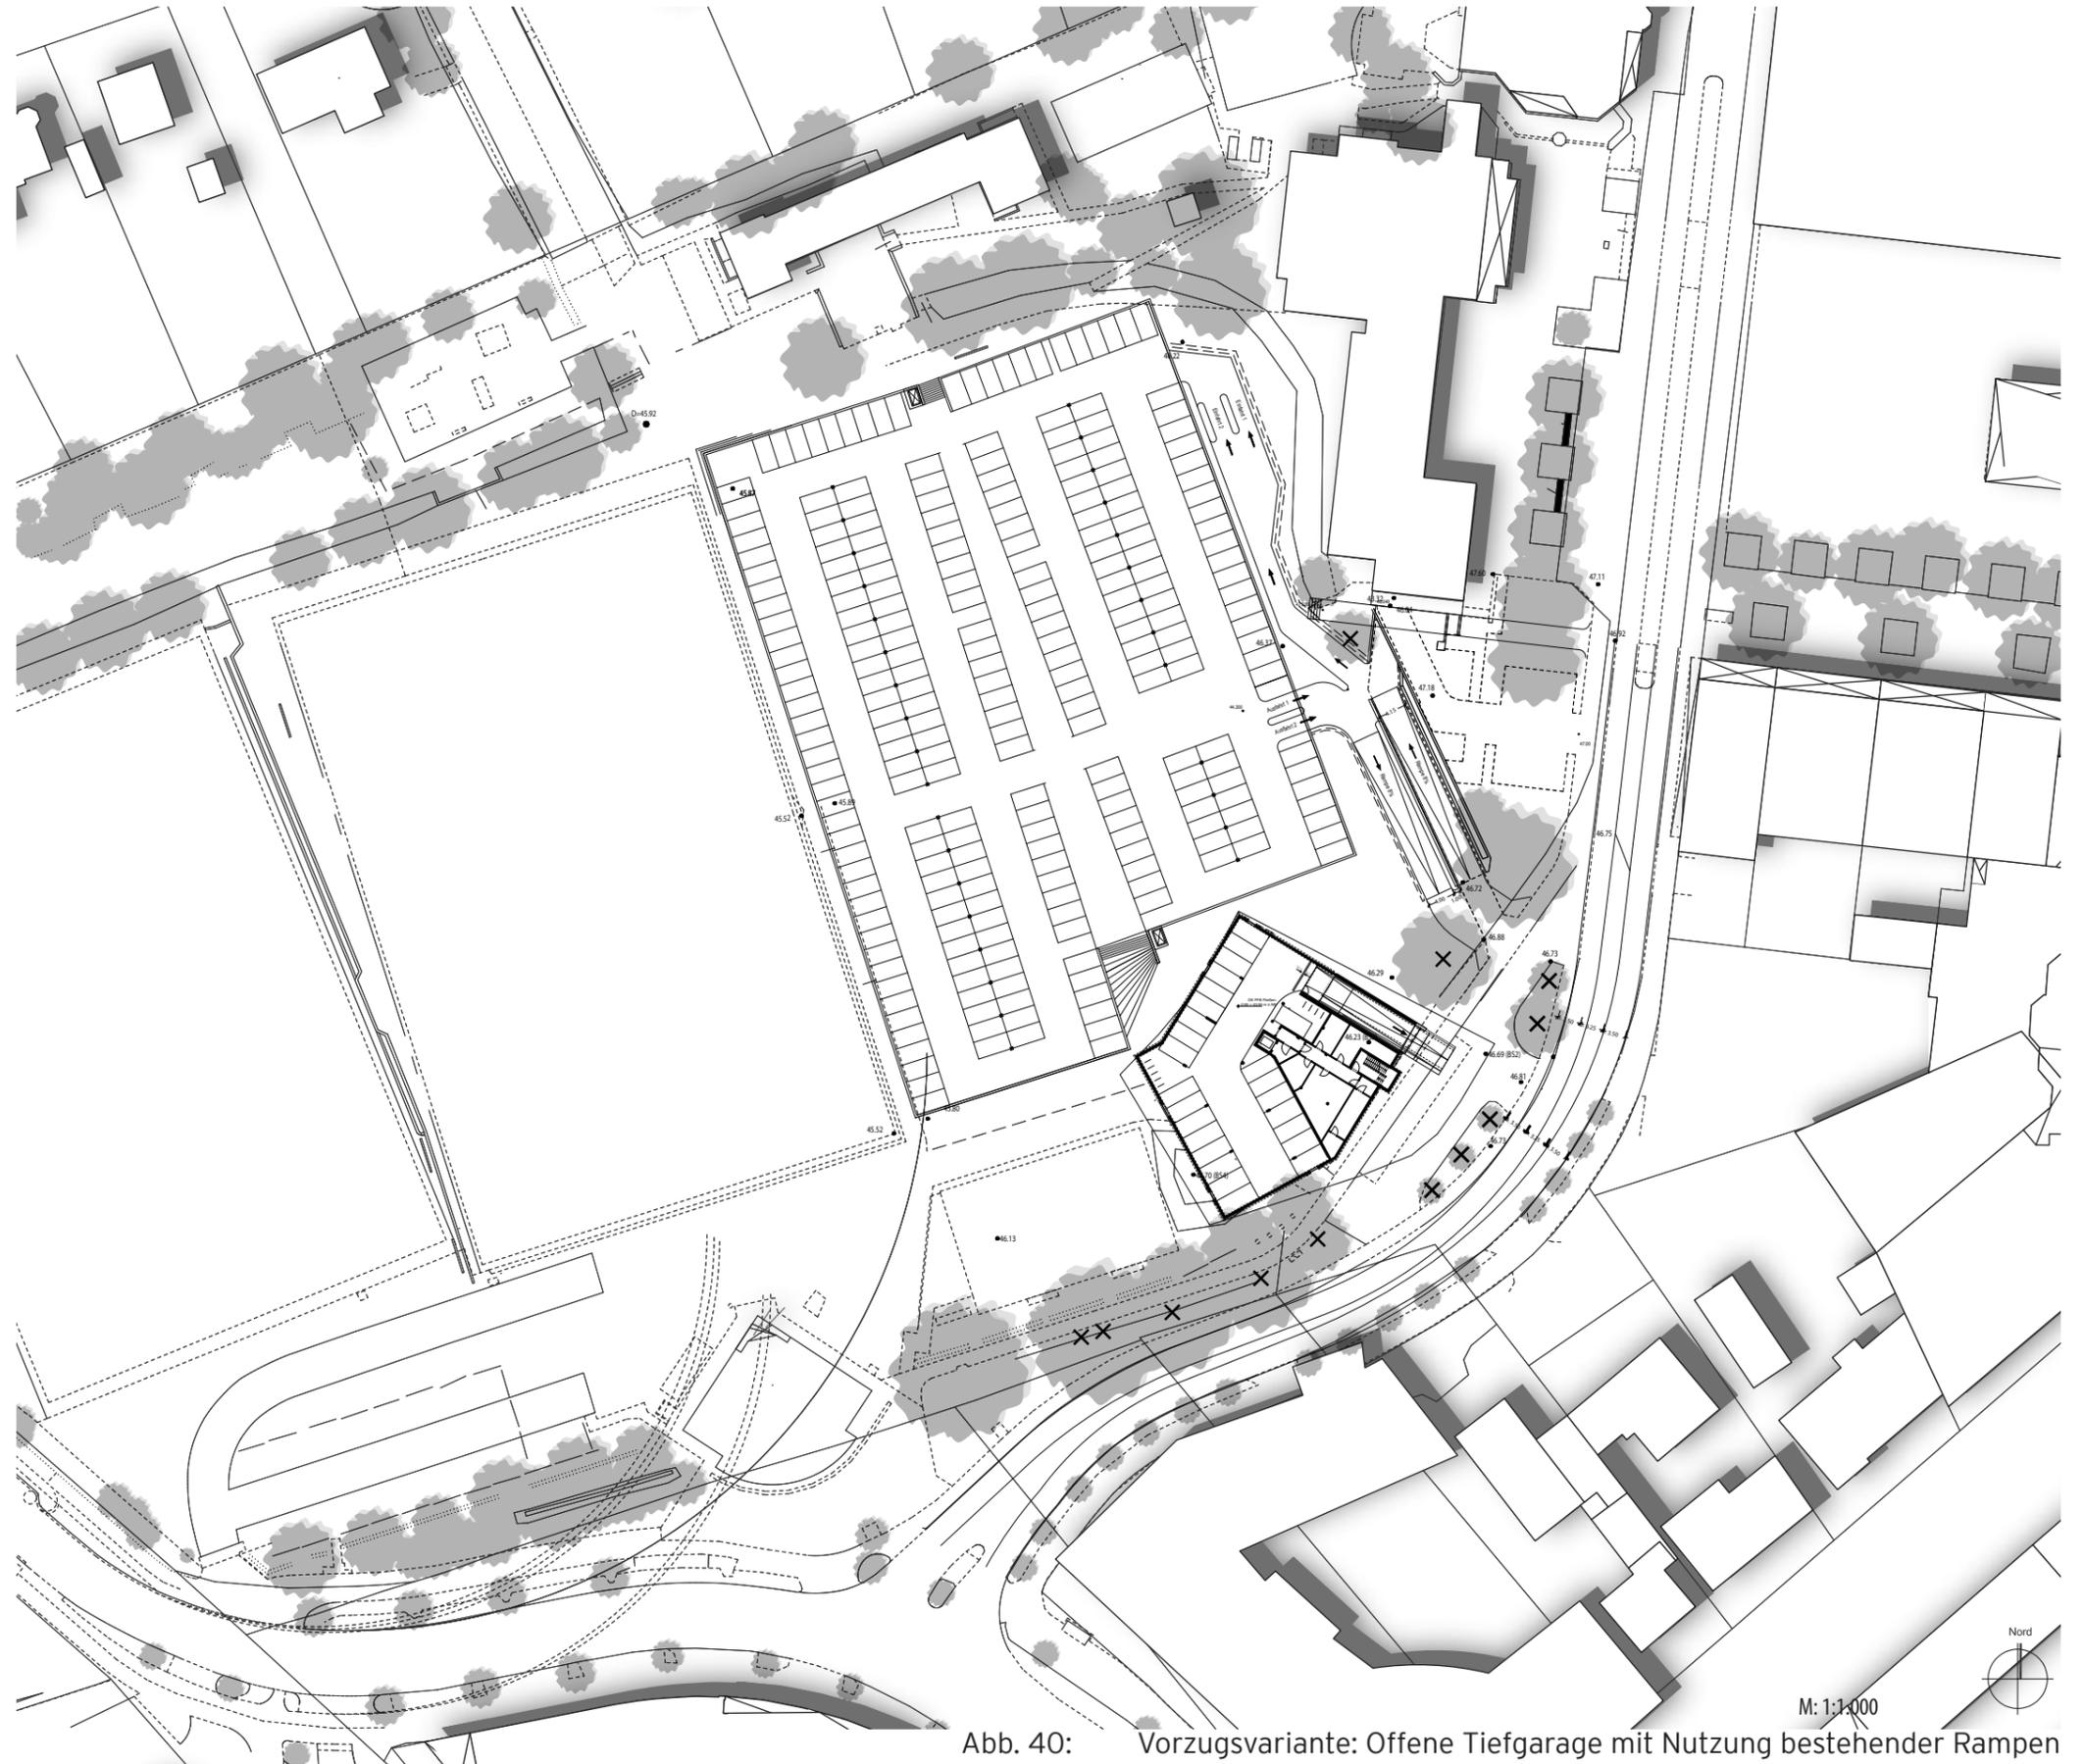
Vorzugsvariante: Offene Tiefgarage mit Nutzung bestehender Rampen
